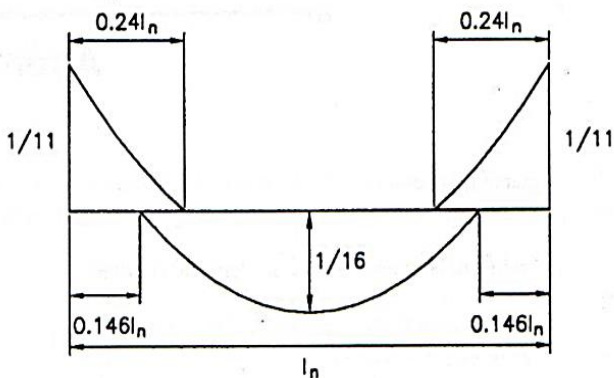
Corte del refuerzo en tramo interior de elemento continuo
